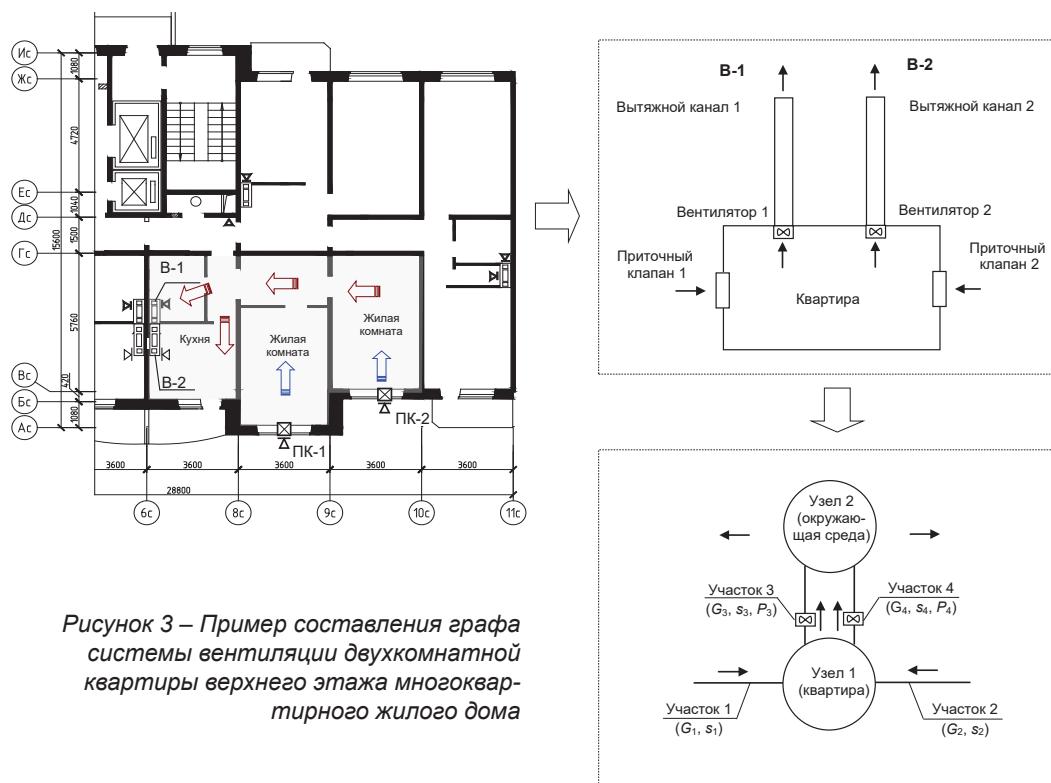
Пример составления графа системы вентиляции двухкомнатной квартиры верхнего этажа многоквартирного жилого дома
